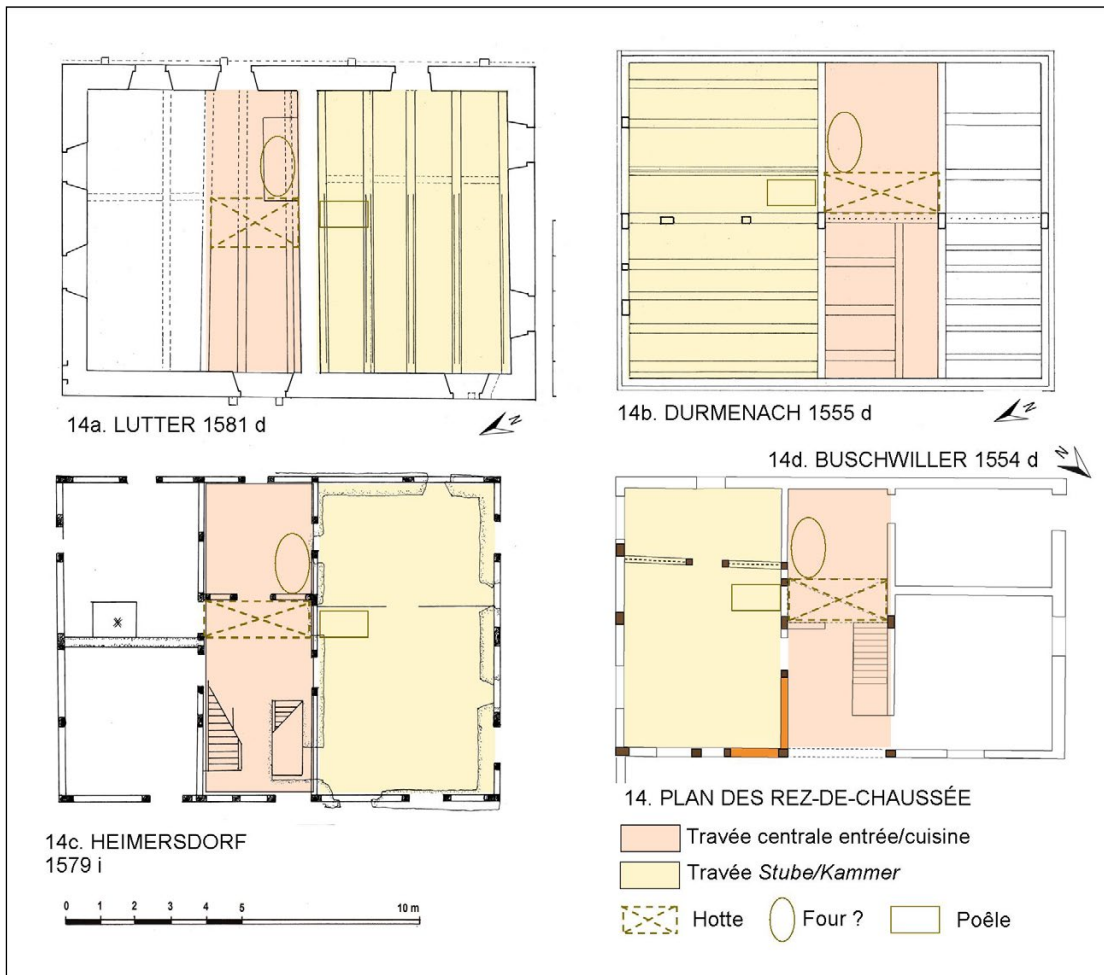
A-B-C-D : Une organisation récurrente qu'il s'agisse de maisons en bois ou en pierre. Au rez-de-chaussée la division *stube-kammer* est assurée par une cloison de planches, au centre l'entrée apparemment sans cloisonnement a vue sur les foyers. La hotte centrale collecte les fumées de l'âtre, du four et du poêle de la *stube*.
